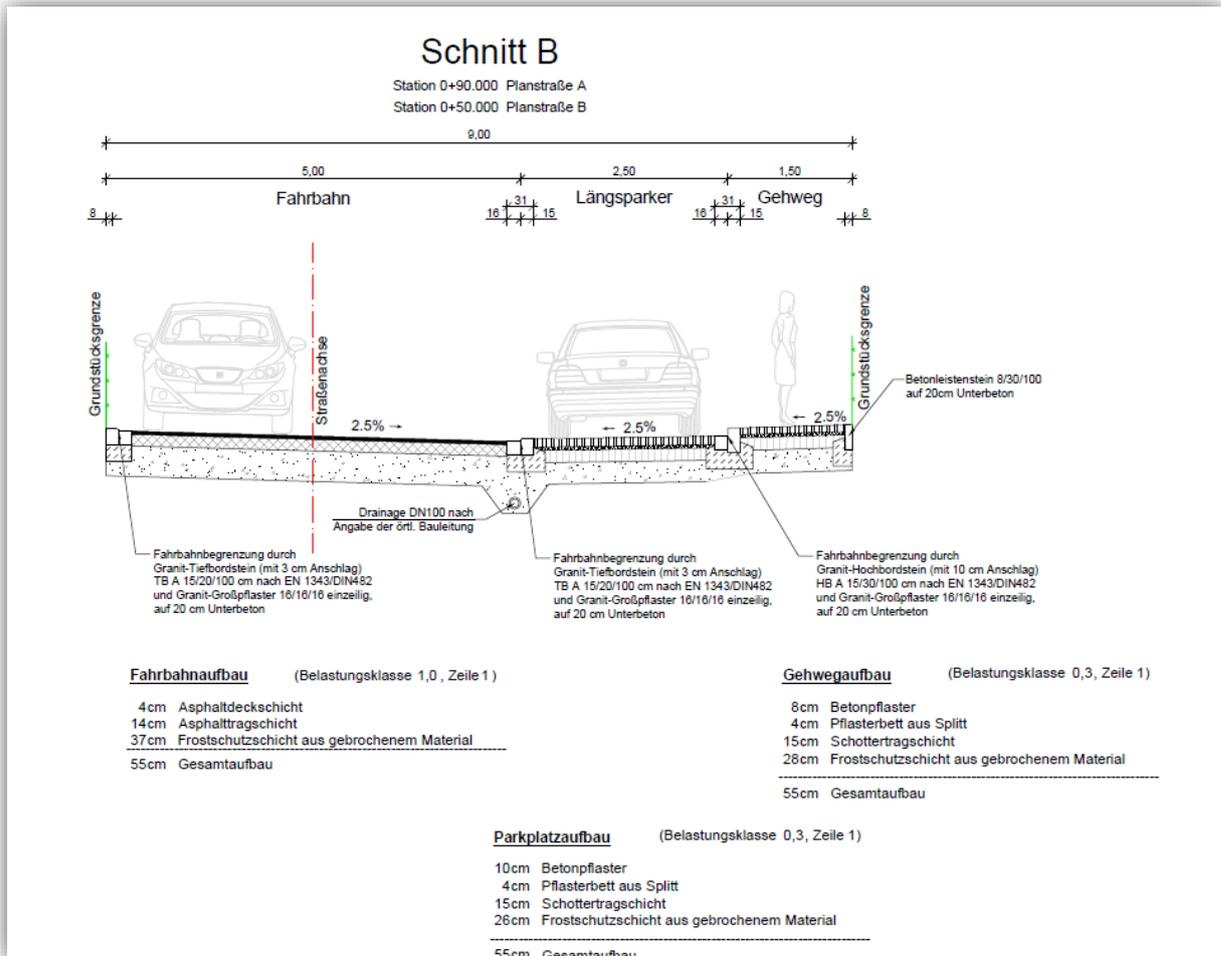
Regelquerschnitt B der Planstraße A und Planstraße B
